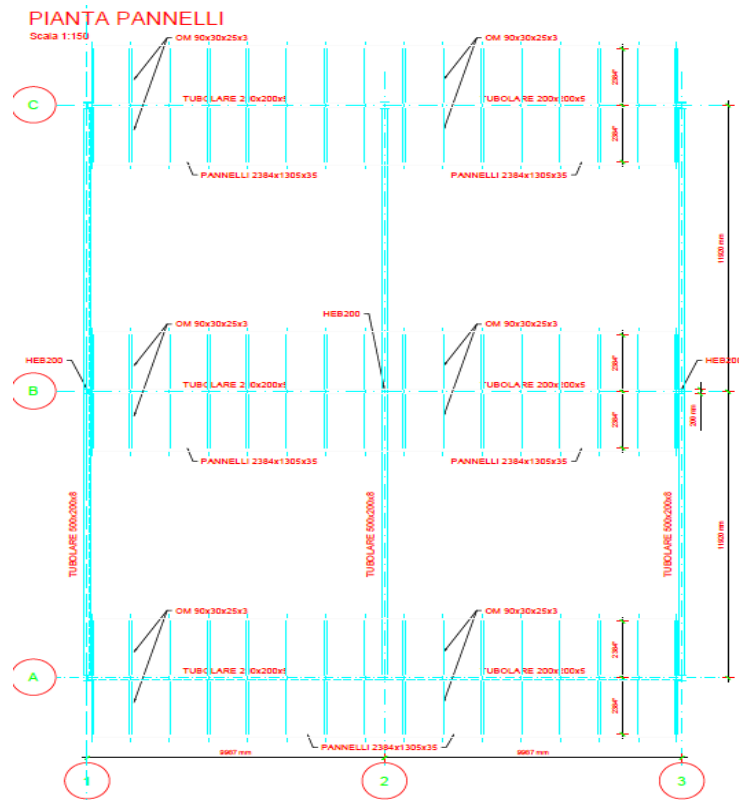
Vista in pianta della struttura "Fissa Alta (Overhead Static (Market) T03)"
